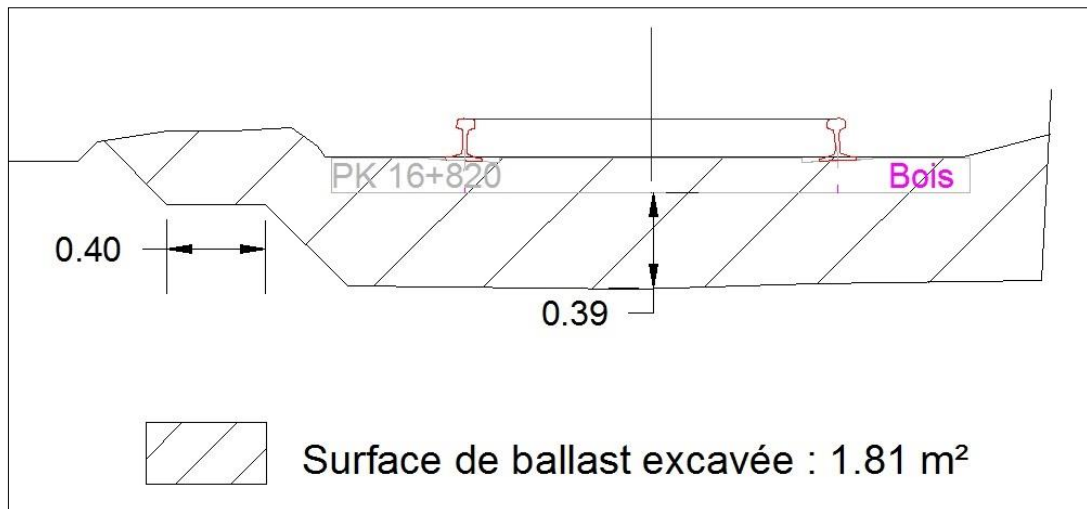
Coupe du radier et du ballast excavé au PK 16 820 V1
